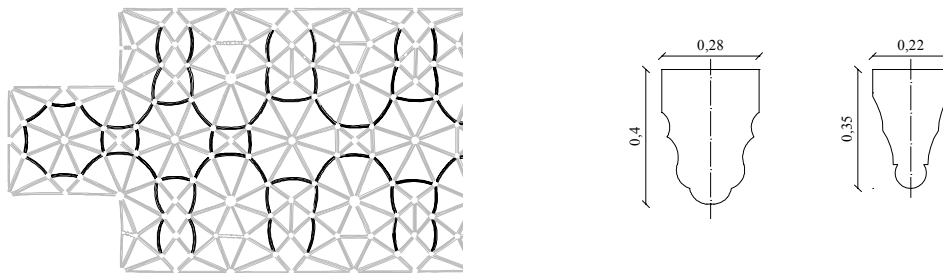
Secções transversais das nervuras (a negro em planta, as nervuras com perfil de menor dimensão)
